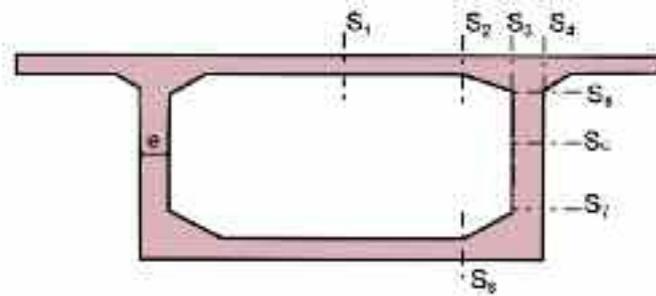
repérage des plans de coupure dans le cas d'une poutre-caisson
